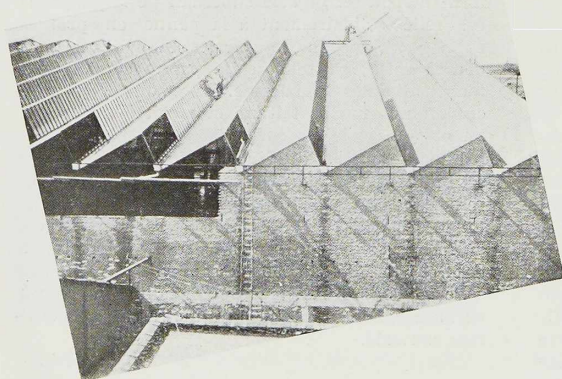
Construction de la nouvelle toiture en voie d'achèvement.
